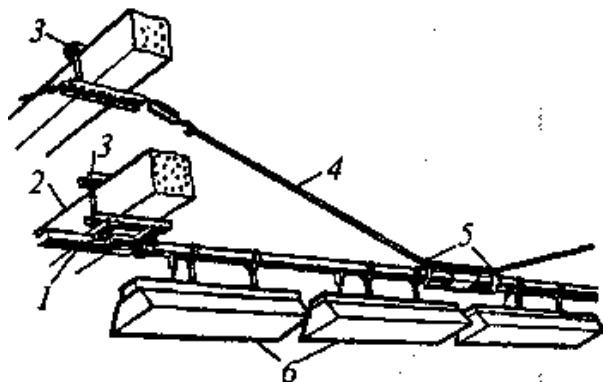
Кріплення шинопроводу впоперек залізобетонної ферми
